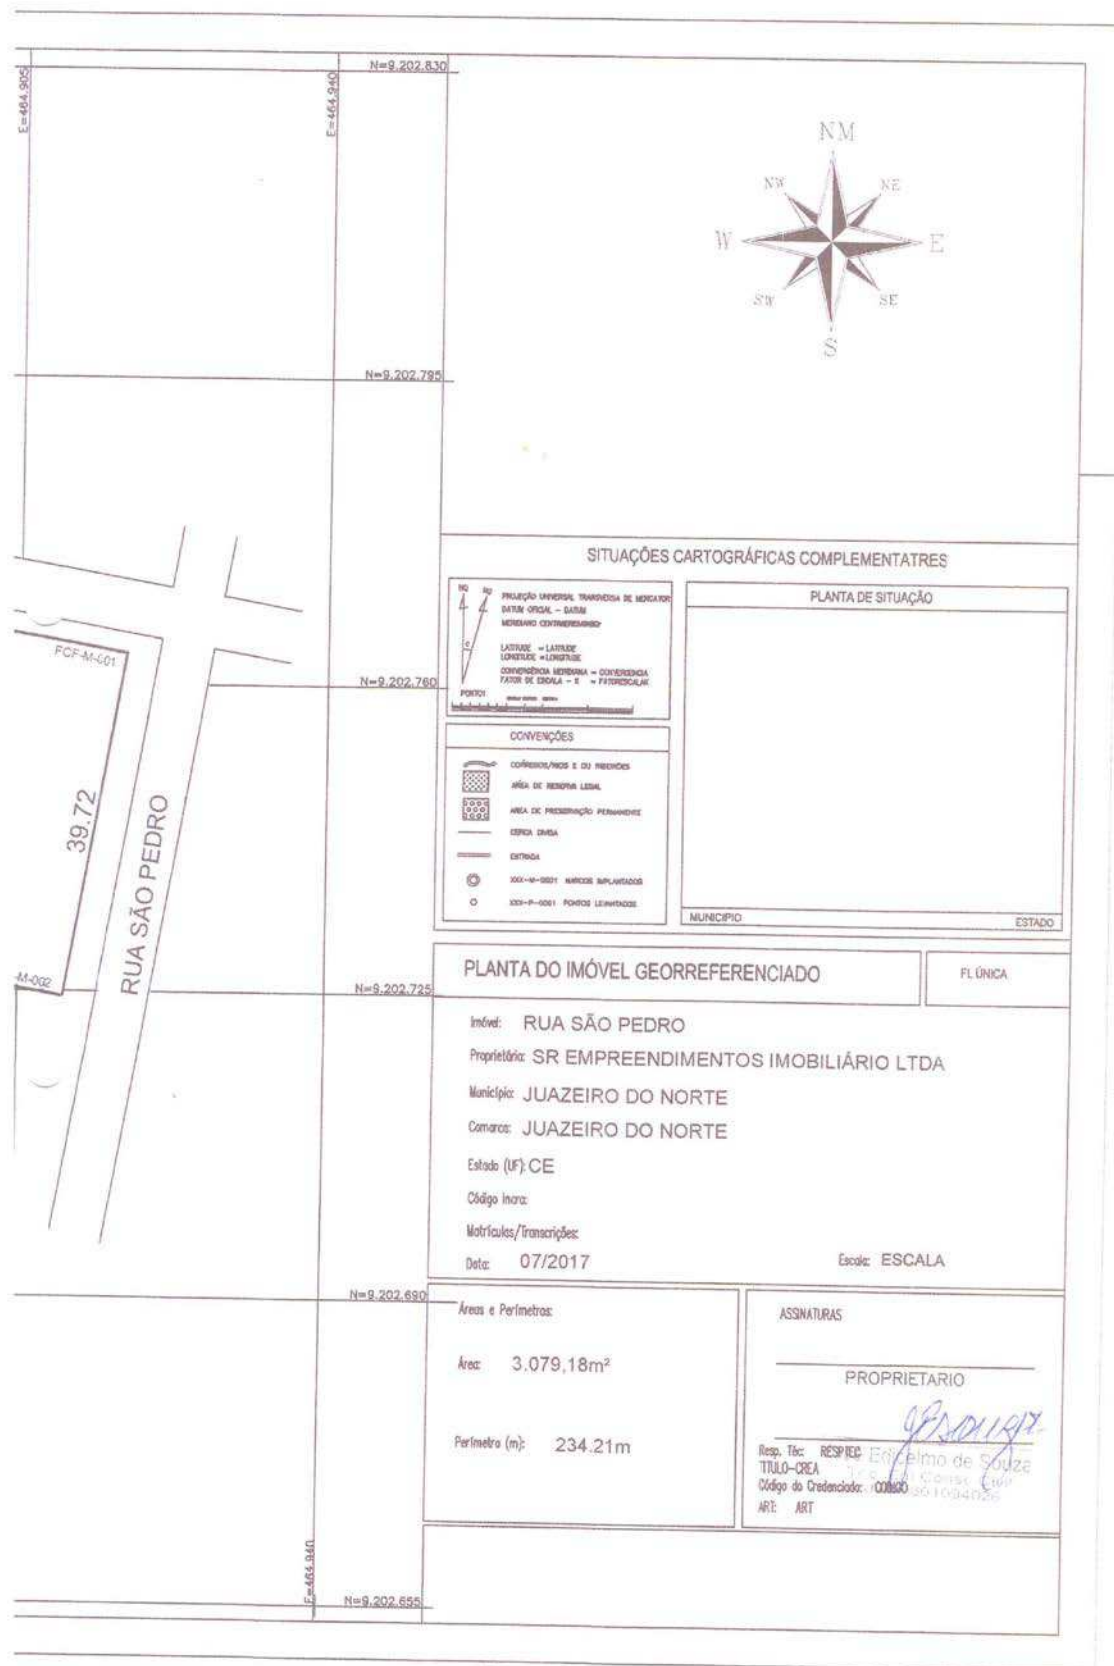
e 3: Planta do Imóvel, elaborada no mês de julho de 2017.
